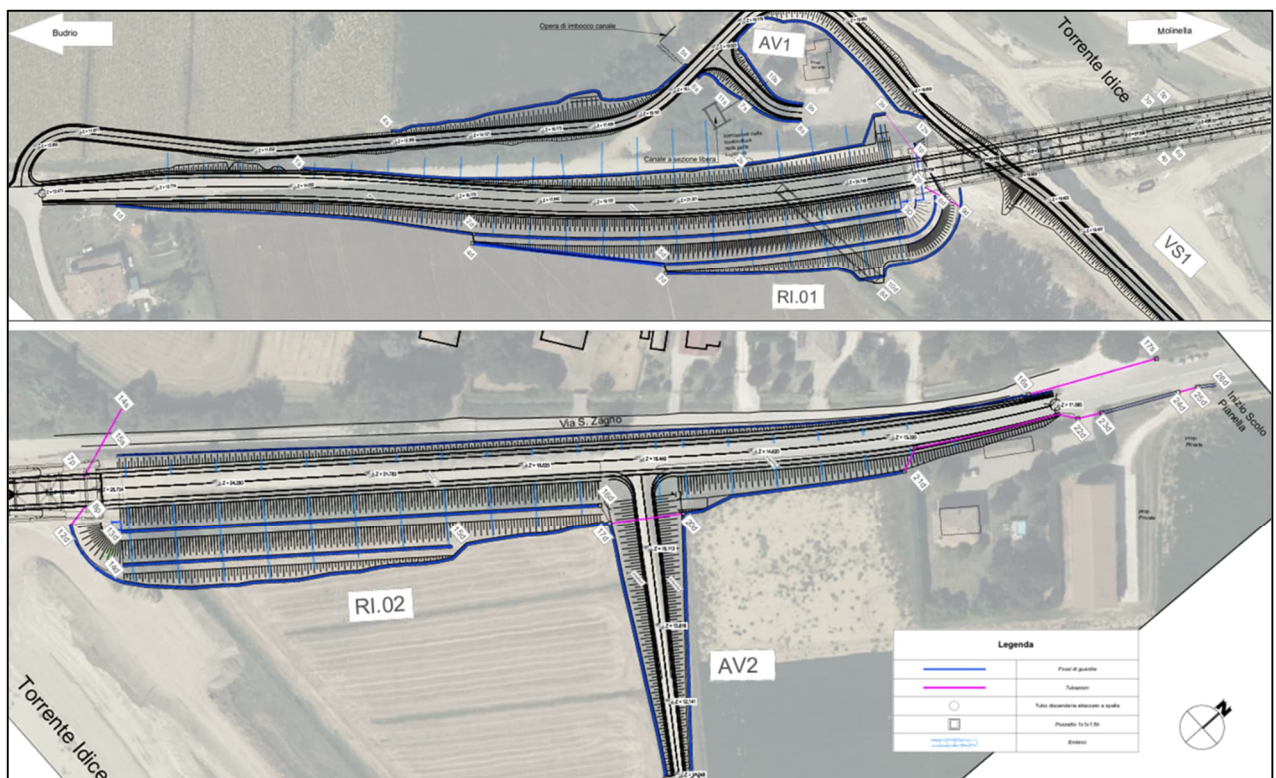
Planimetria area di intervento con indicata ubicazione rete di smaltimento
